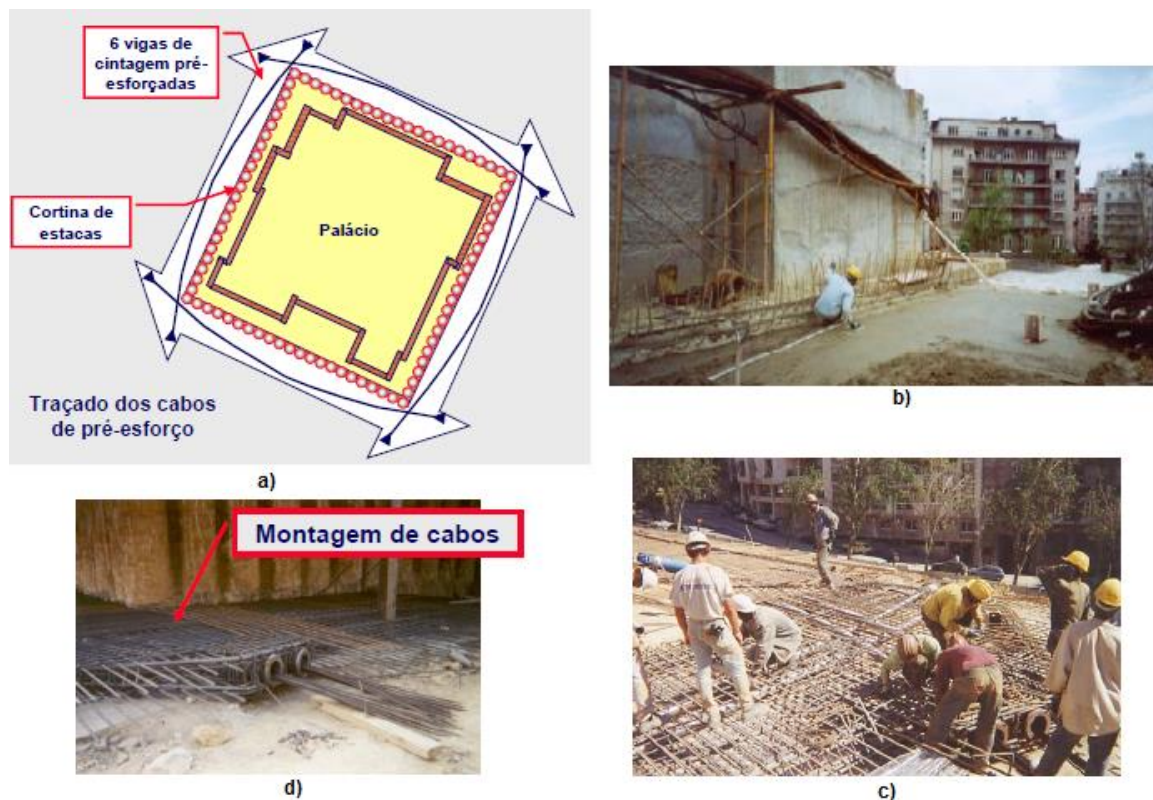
Contenção do palácio: a) planta esquemática; b) preparação do terreno para a construção da viga do 1º nível; c) execução da armadura da viga do 1º nível; d) montagem dos cabos de pré-esforço [67]
